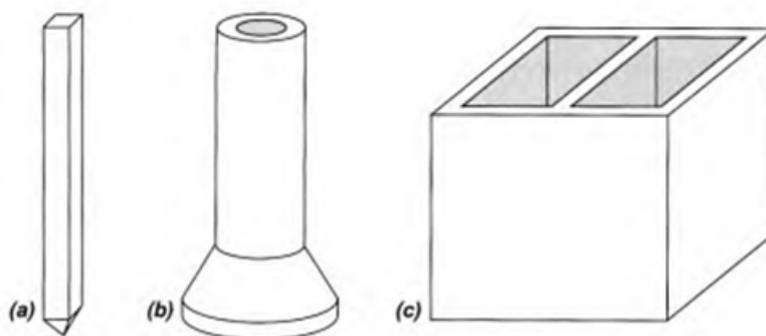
tipos de fundação profunda. (a) estaca, (b) tubulão e (c) caixão
